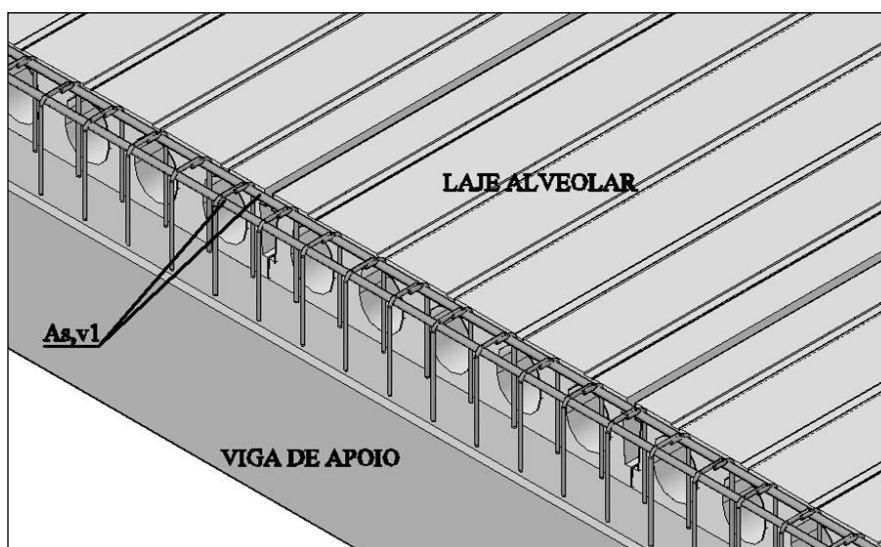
10 – Detalhe de inserção da armadura  $A_{s,vl}$  no pavimento.
